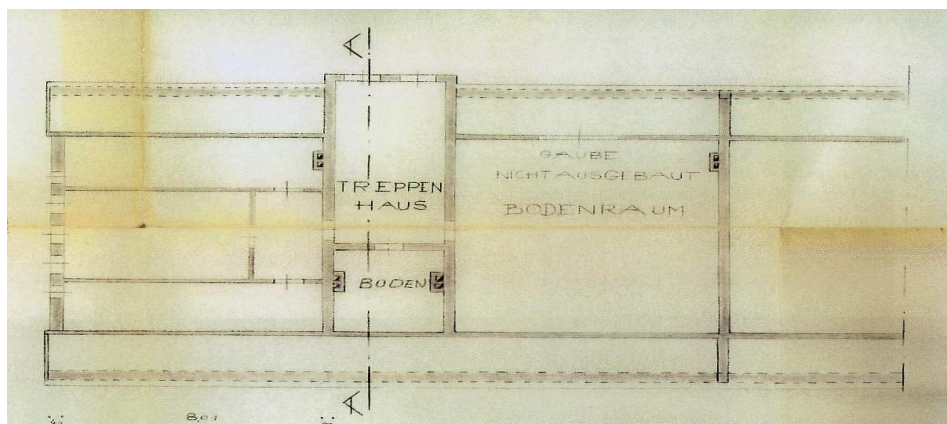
M.1 Dachgeschoß, Ausschnitt Umbauplan (undatiert)
